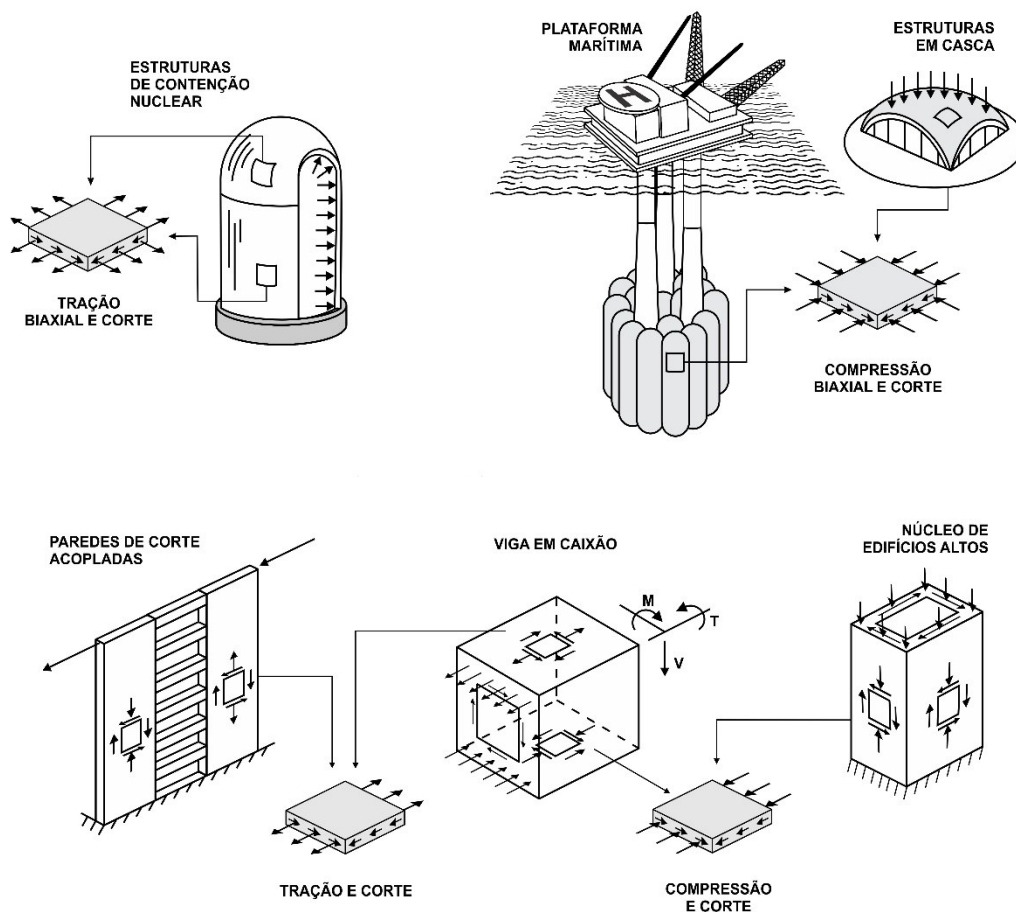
Simplificação de estruturas de concreto armado em elementos do tipo placa.
